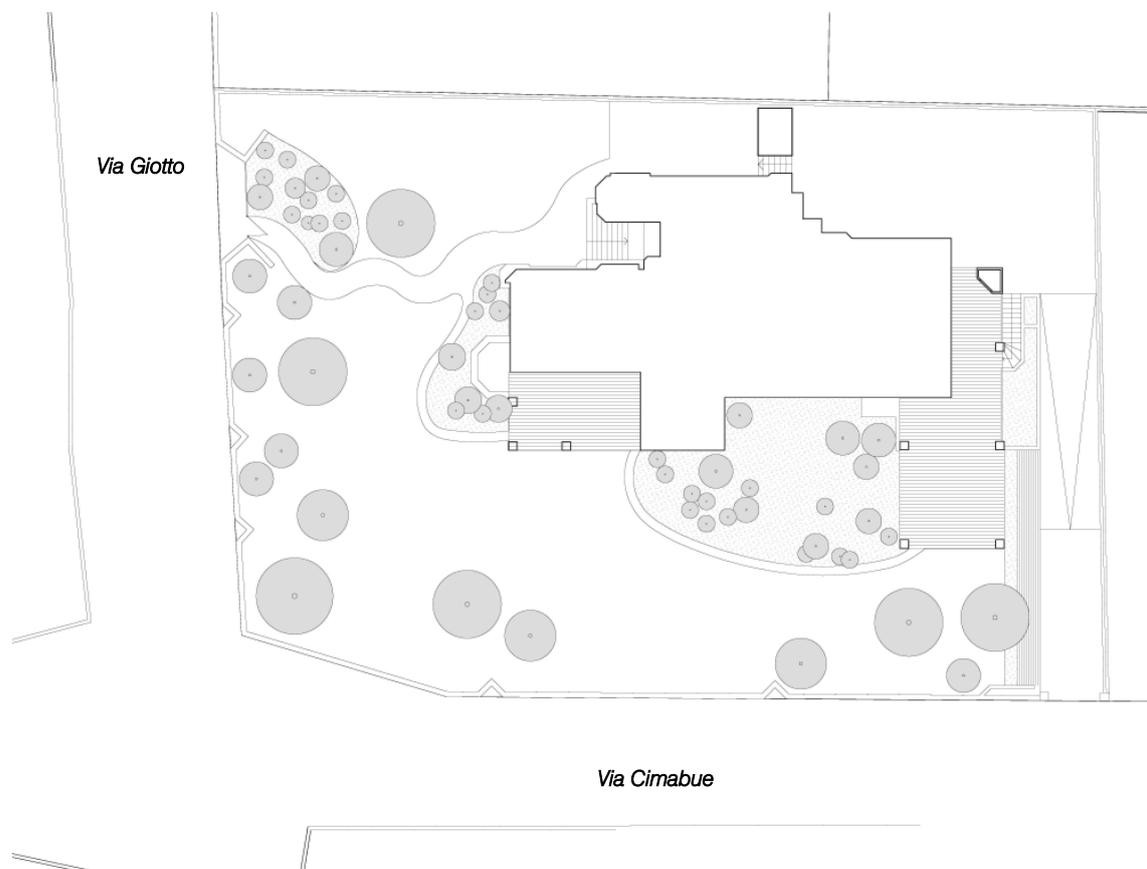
Lotto di intervento – planimetria stato di fatto
